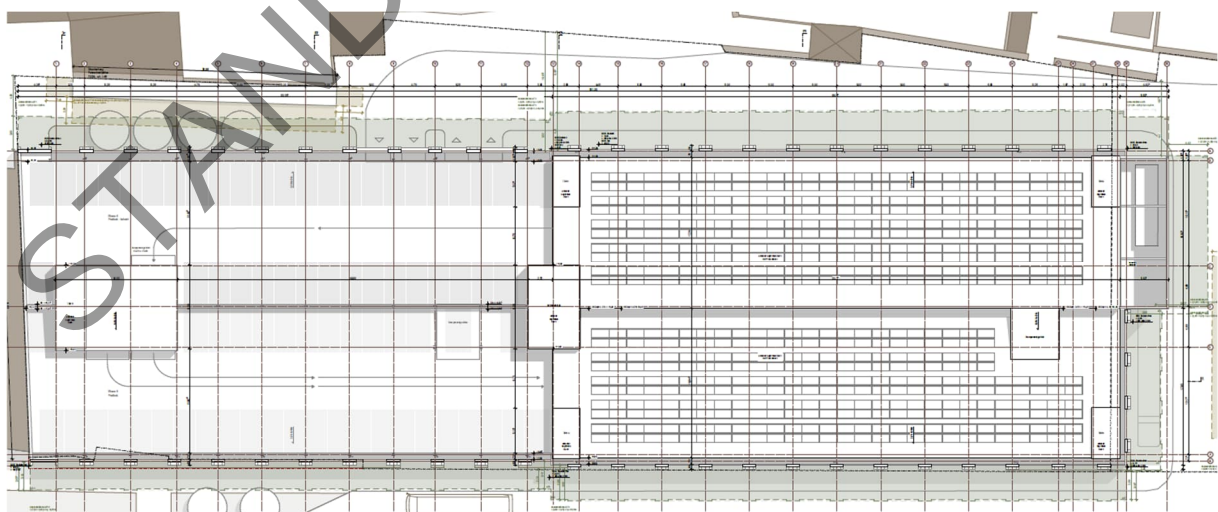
Darstellung der gemäß Art. 6 BayBO vorgeschriebenen Abstandsflächen von 0,4 H (grün um das geplante Parkhaus, braun um die Fahrradabstellanlage; Nachbargebäude grau-braun, Grünflächen hellgrau, Beläge/ Zufahrt rechts und oben/ Wittstraße unten in weiß) (Darstellung der Dachaufsicht von Feigel - Dumps Architekten).
